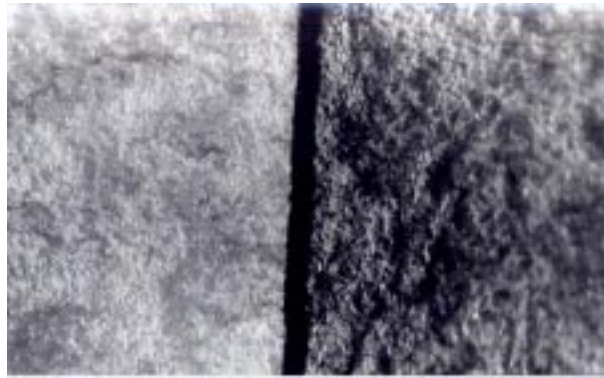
Fenda ao longo da aplicação da carga - Flexão-em-três-pontos – CP longitudinal.
